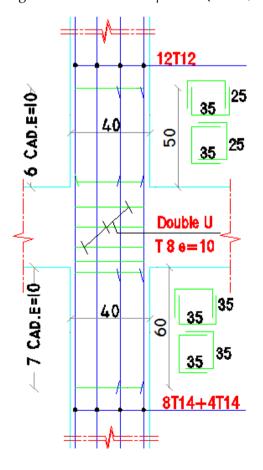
Ferraillage de recouvrement des poteaux (40×40) cm² et (40×30) cm².
